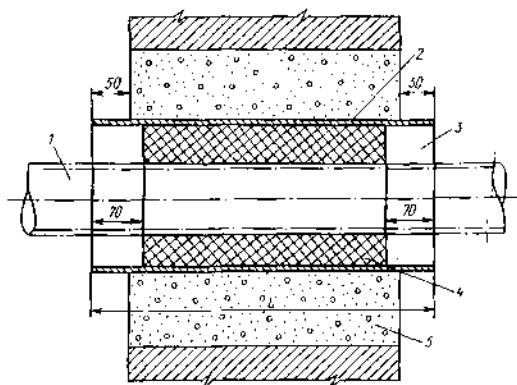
Футляр для прохода газопроводов через фундаменты и стены.
